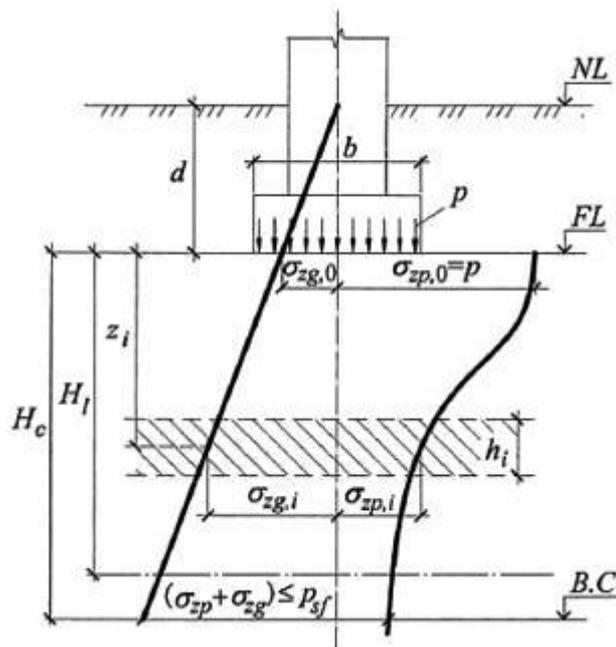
Схема для расчета суффозионной осадки засоленного грунта при вертикальной фильтрации
